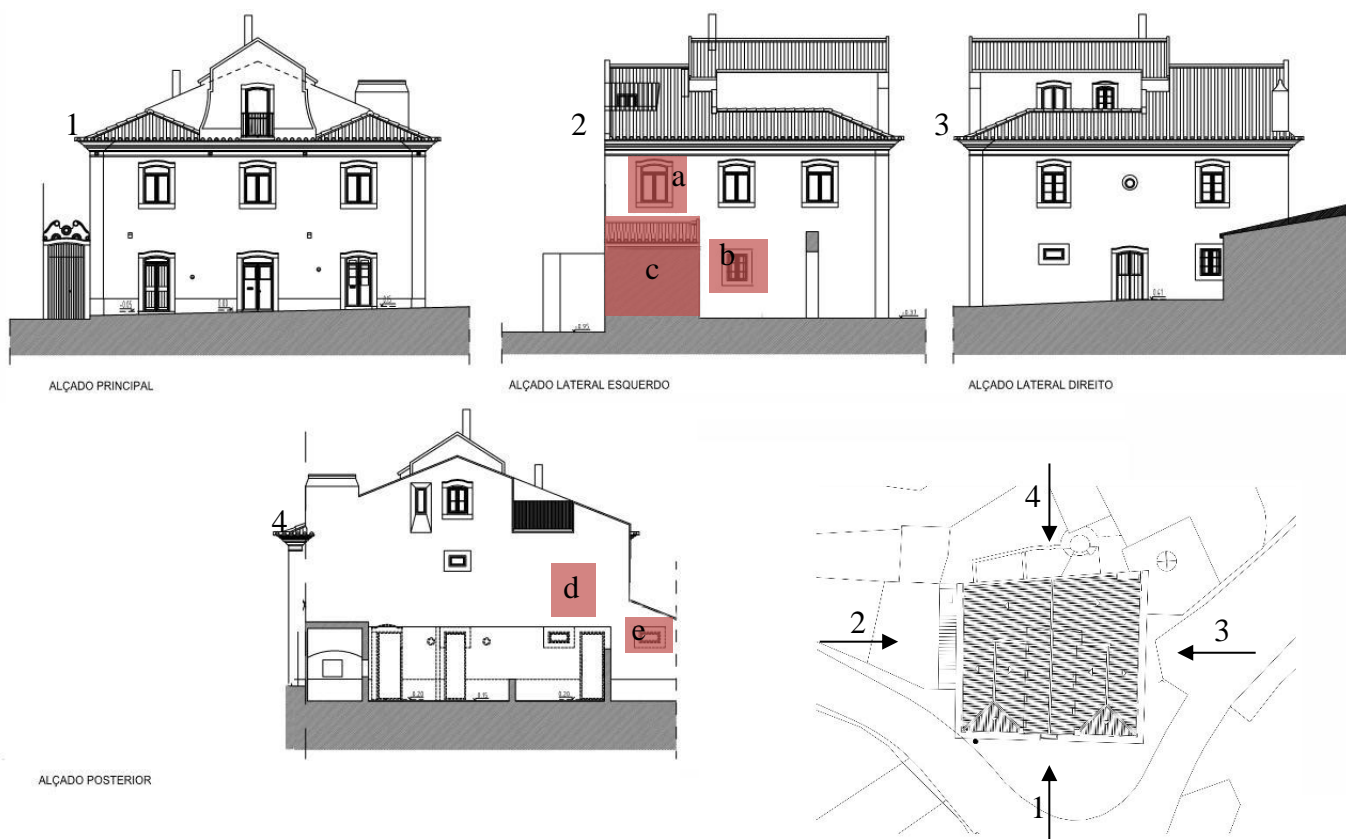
Proposta final do exterior da Casa D. Miguel sem escala.
